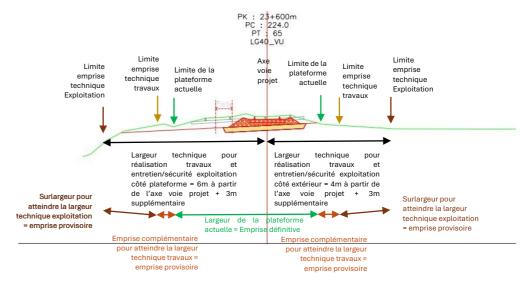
Coupe en travers de la mise en place du projet et des emprises de la plateforme
